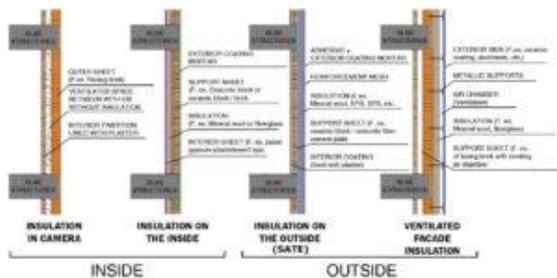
Ilustrasi pengaruh facade terhadap suhu ruang dalam bangunan
